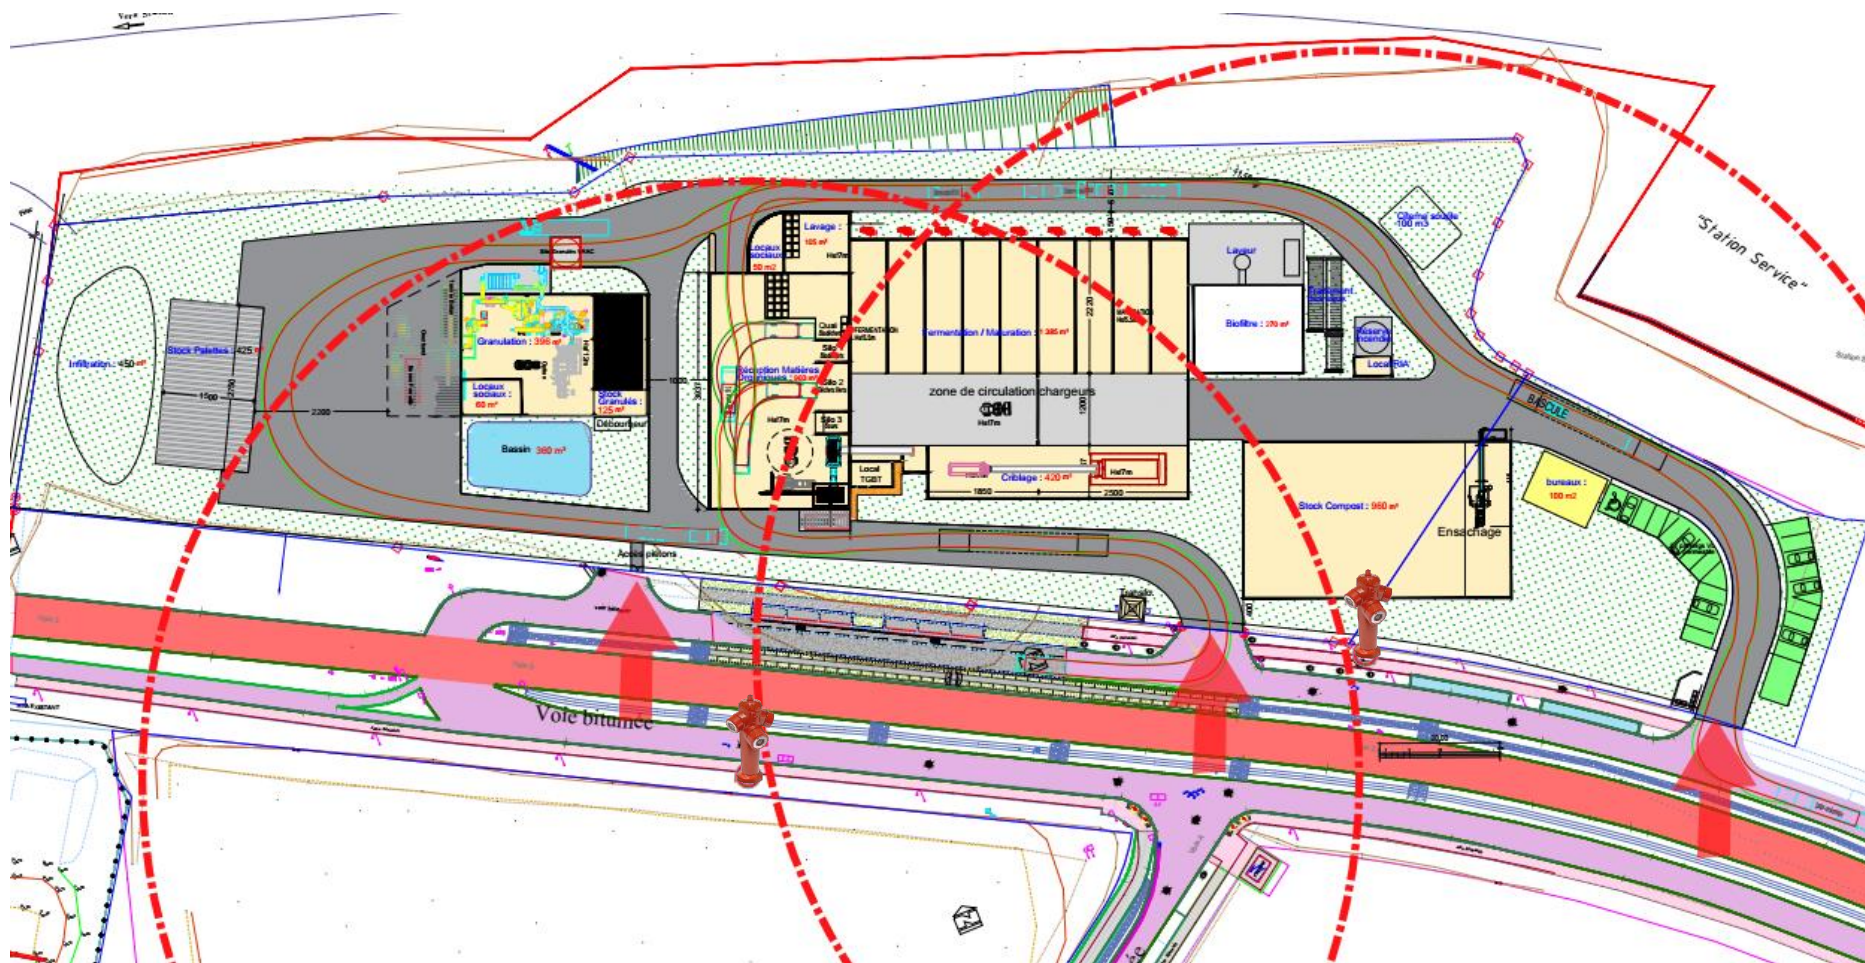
Plan du site avec poteaux incendie et entrées du site
